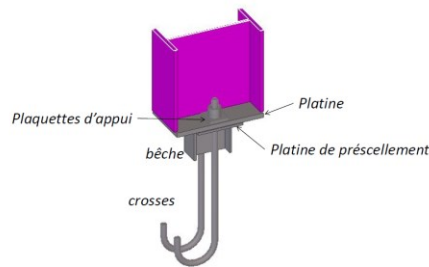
pieds de poteaux articulés avec dispositif de bêche anti-glissement
